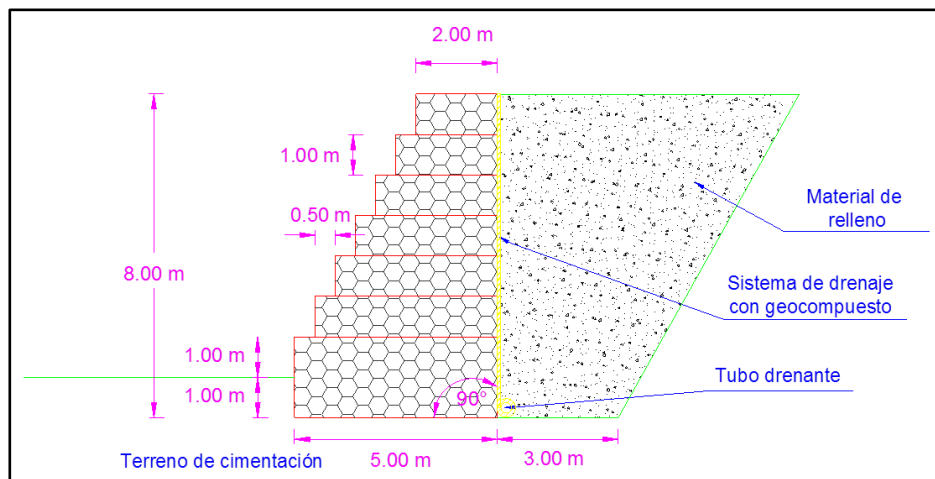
Detalle del muro de gaviones colocado al pie del talud 5.
